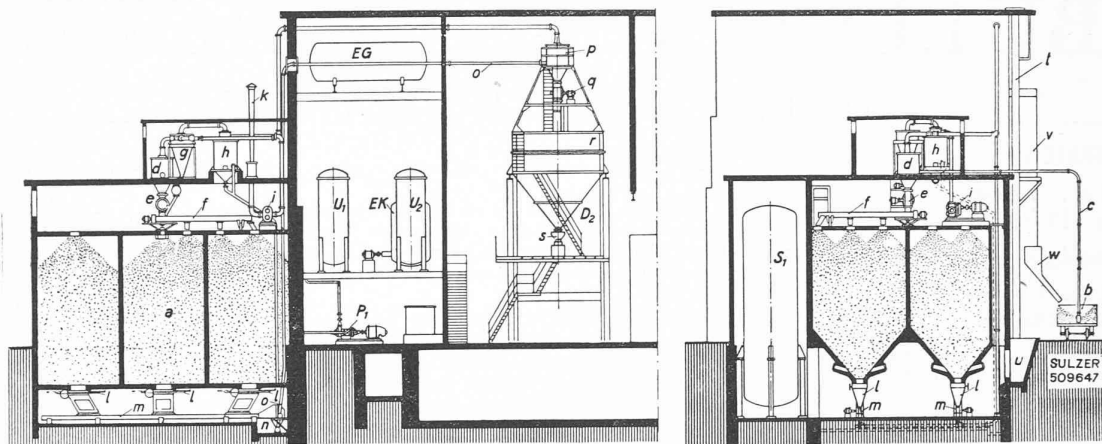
Centrale de Pierre de Plan. — Coupe par la centrale de chauffage, la salle des appareils et la soute.
